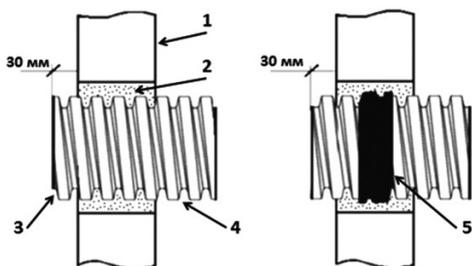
Ввод трубы типа «ССД-Пайп» в стену железобетонного колодца: 1 – наружная поверхность стены колодца; 2 – отверстие в стене колодца заполненное строительным (цементно-песчаным) раствором; 3 – выход трубы внутри колодца для надевания наружной заглушки; 4 – труба «ССД-Пайп»; 5 – кольцевой бандаж из ленточной мастики типов ЛМ или МГ 14-16.
